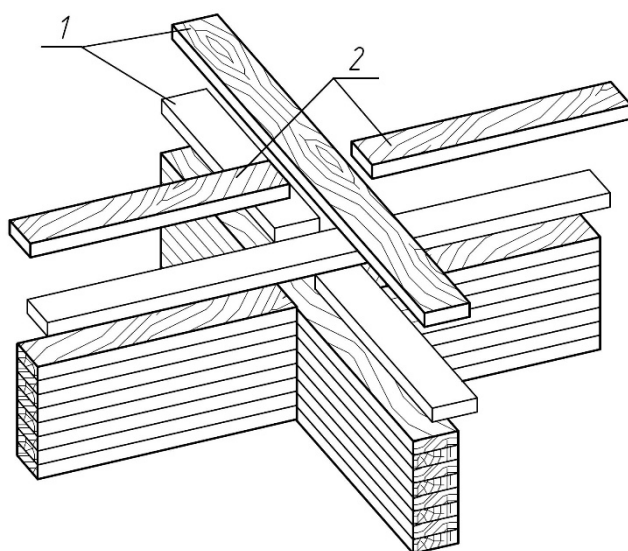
Конструкция узла сопряжения элементов способом “перекладки слоёв”:
